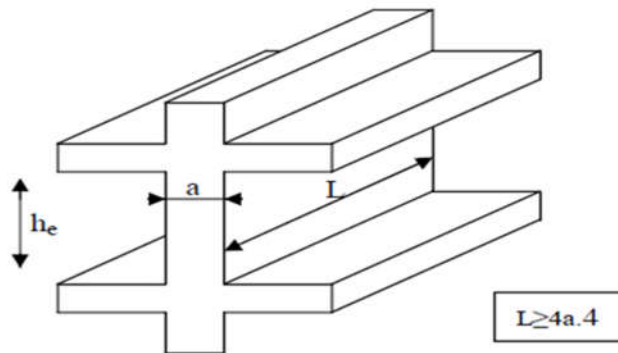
COUPE DE VOILE EN ELEVATION.
